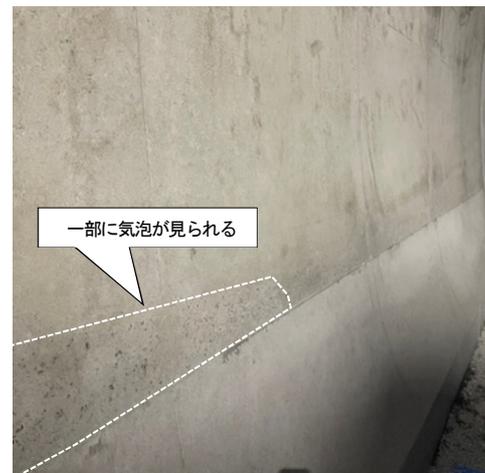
脱型直後のコンクリート表層状況 (側壁部)
